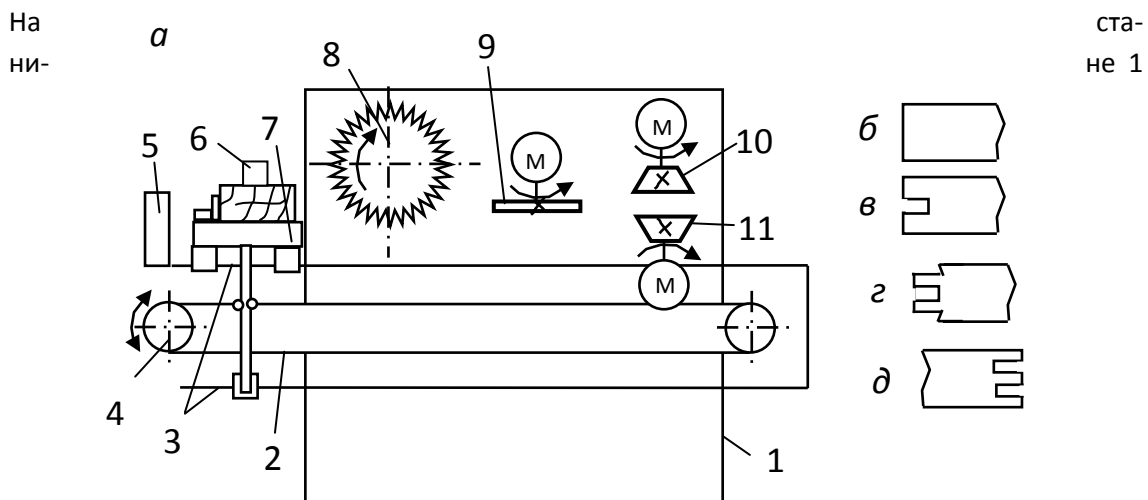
Односторонний рамный шипорезный станок ШО15Г-5: *а* – технологическая схема; *б* – заготовка после обработки пилой; *в* – заготовка после обработки проушечным диском; *г* – готовые концы детали; *д* – концы ответной детали
